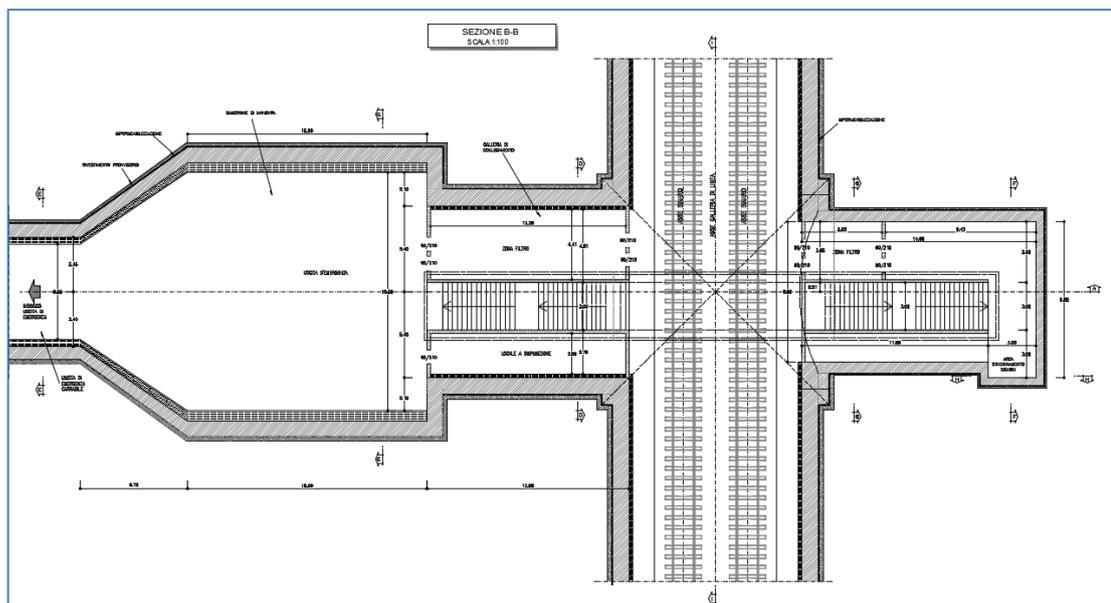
Galleria Le Forche – Finestra carrabile – Pianta (Rif. [20])
